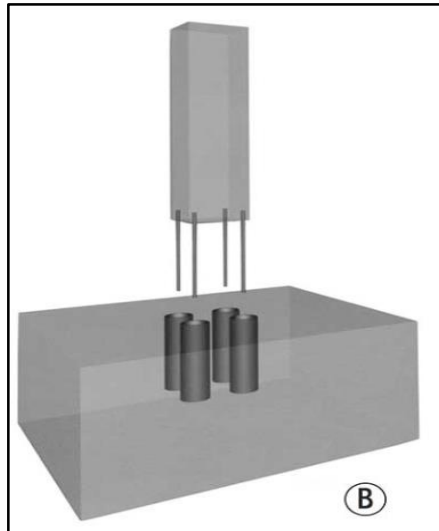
Conexión columna-zapata con barras de proyección. Fuente: (Penagos Congote, 2017).
